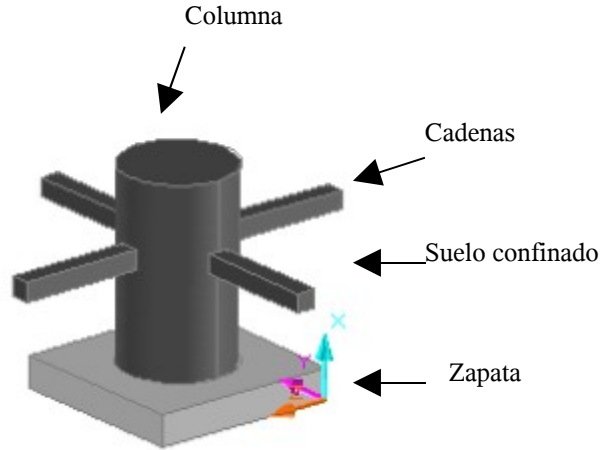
Esquema real de la cimentación con zapatas aisladas.
